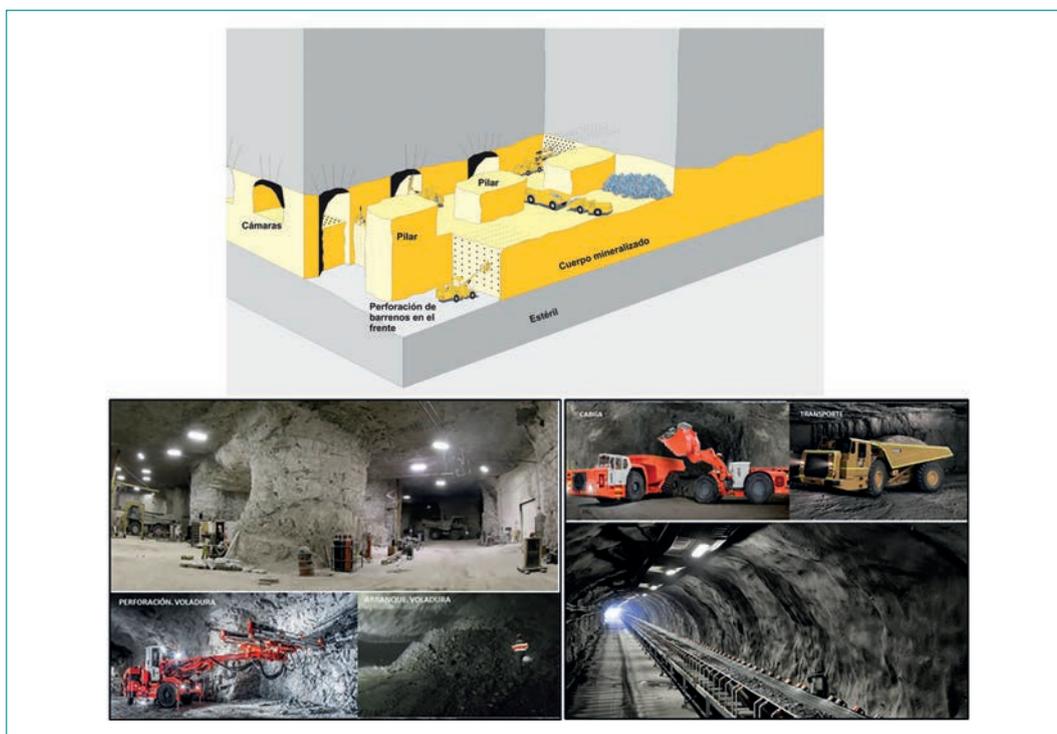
Esquema de una explotación por cámara y pilares (minería subterránea). Fuente: modificado por los autores de (Atlas Copco, 2007) y elaboración propia de los autores.
